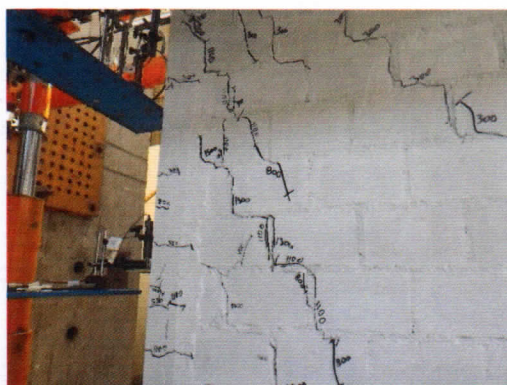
Formación de grietas diagonales en la parte superior Oeste de la cara Sur para una distorsión de 1/300.
